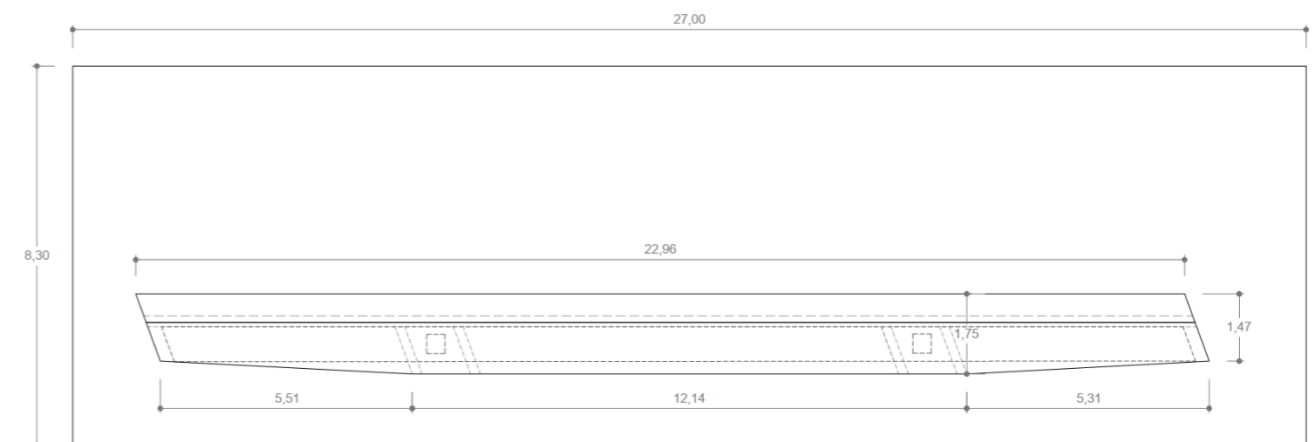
Vista en planta de las zapatas y estribos (fuente: elaboración propia)
